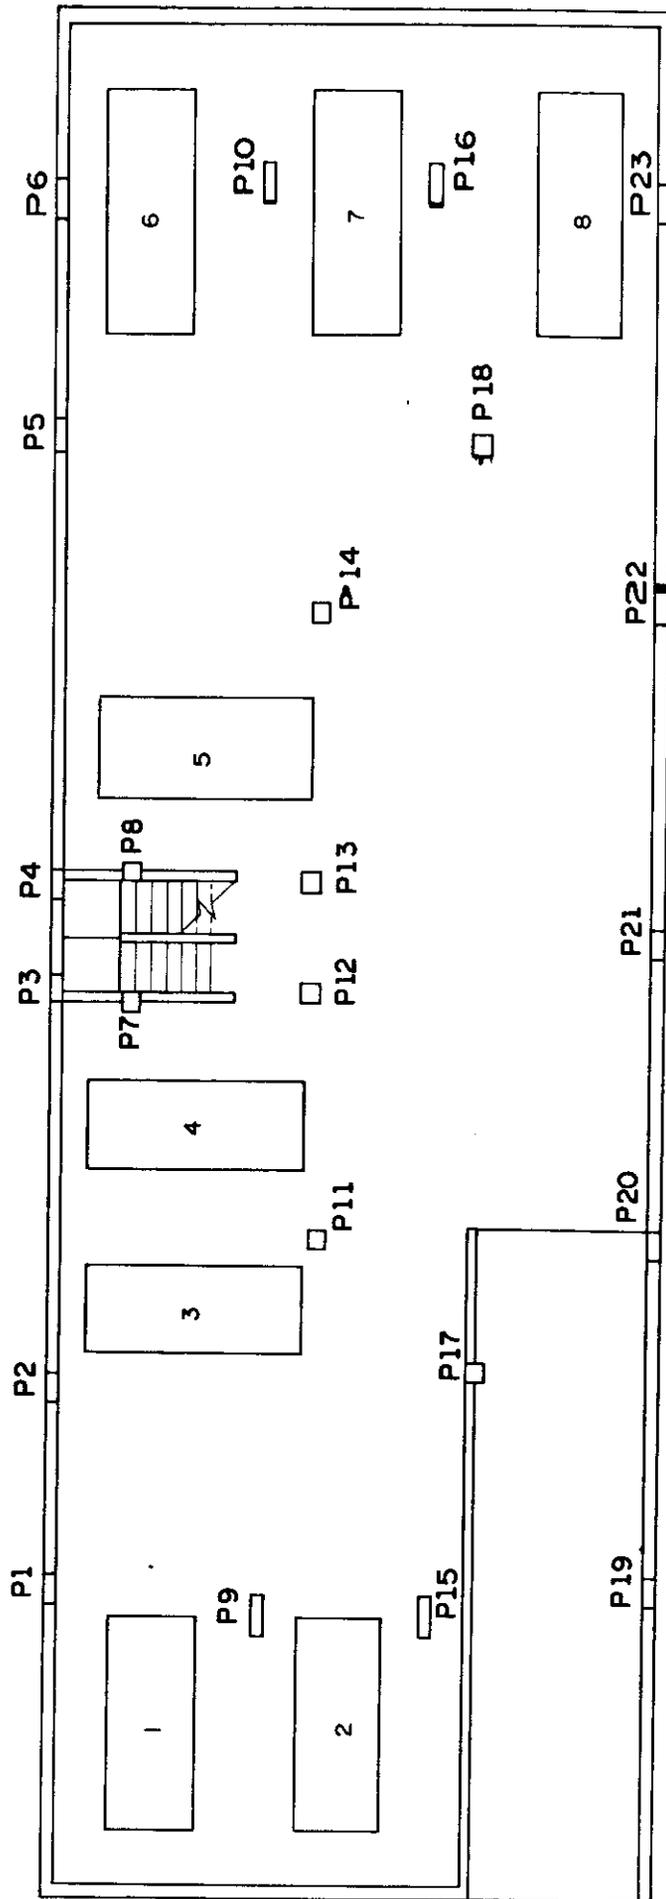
c - Estrutura I - Posicionamento dos Pilares no Subsolo do Edifício B
